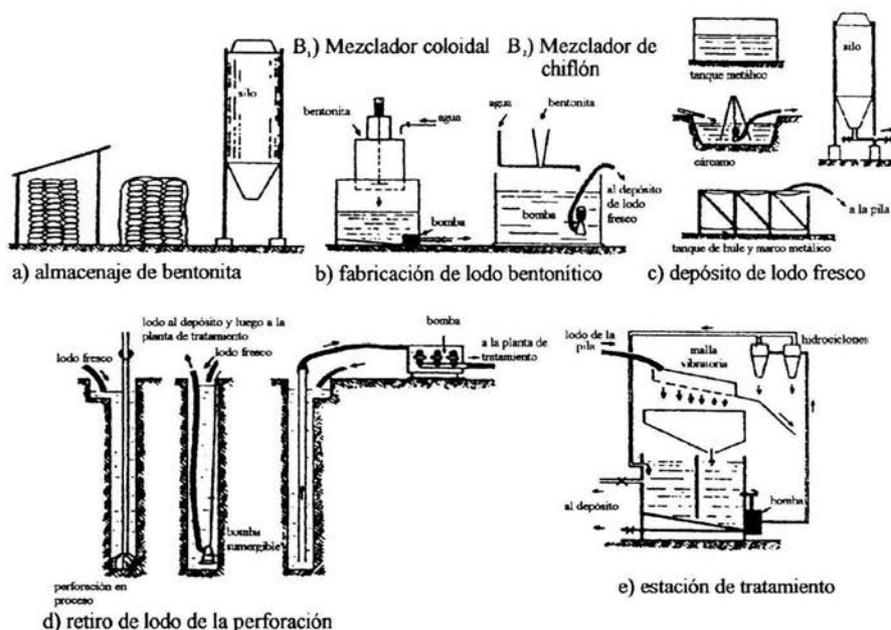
Planta de lodos tipo (LCPC, 1986).
